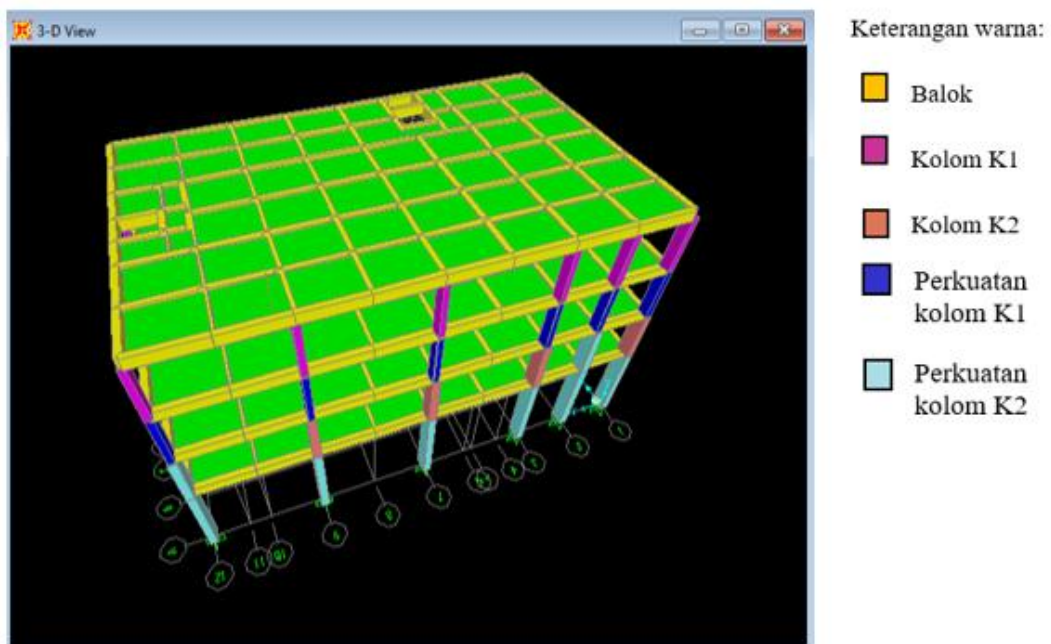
Tampilan *Deformed Shape* sebelum diberikan beban tambahan
